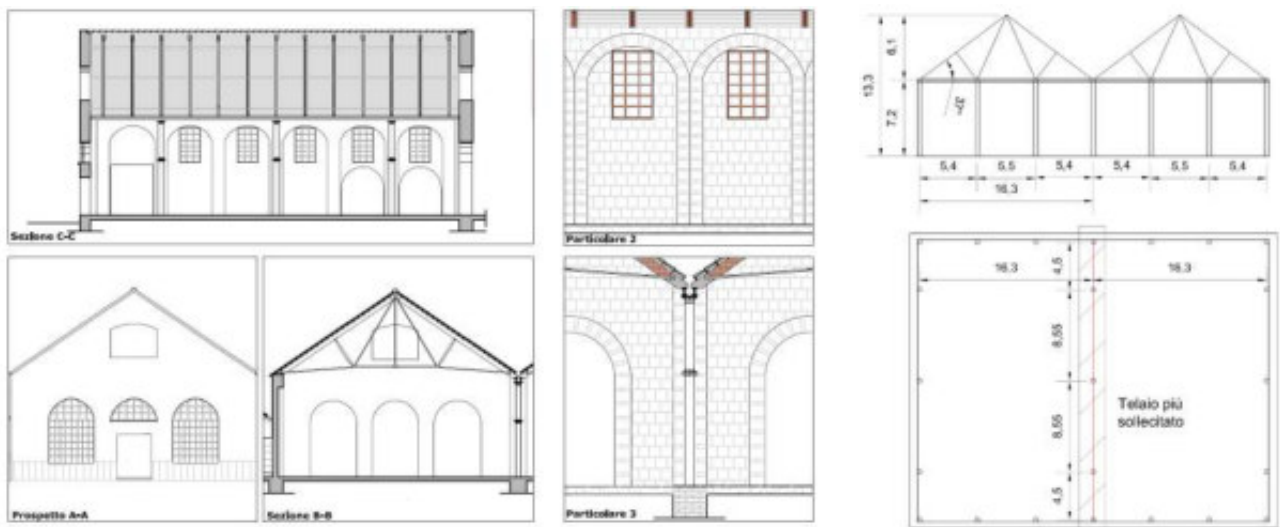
Edificio 8, Capannone ex-fonderia getti. Scheda di progetto da PFTE e schematizzazione strutturale.
